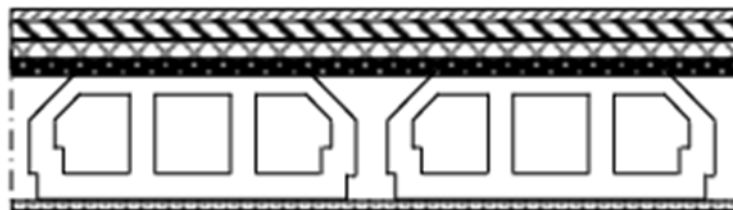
Détail Des Constituants Du Plancher Terrasse Inaccessible
